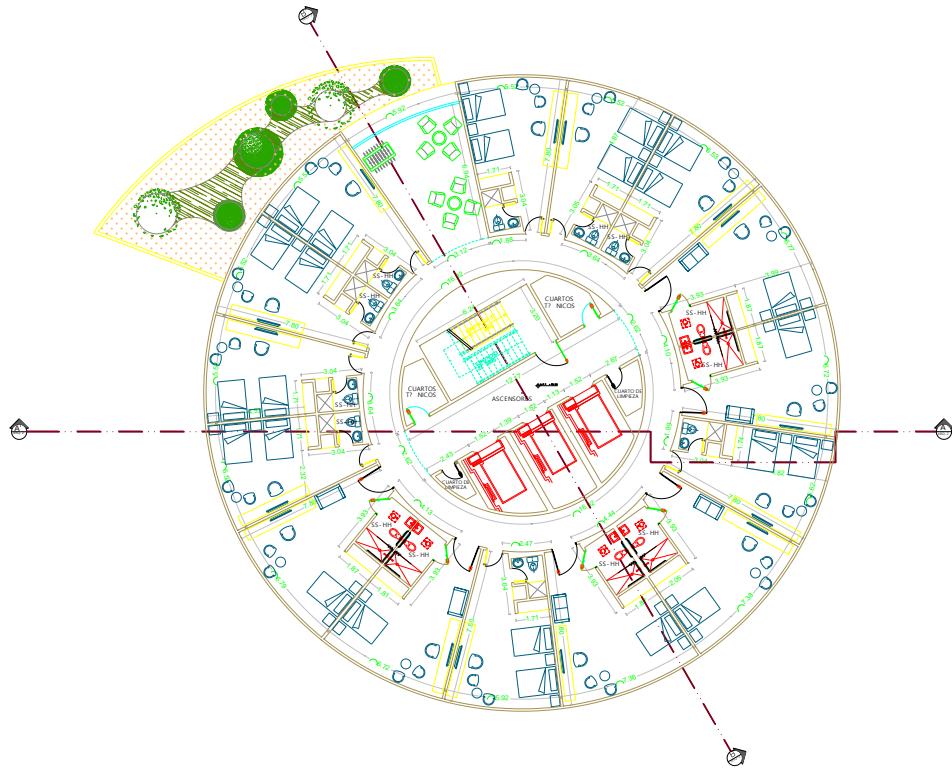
Planta alta N+12.16 arquitectónica de Zonas complementarias – Hospedaje
